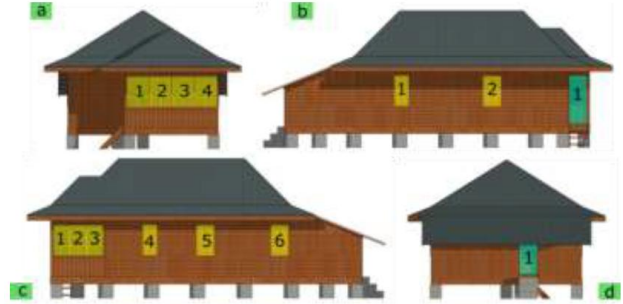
a. Persepektif bangunan, b. tampak samping kanan, c. tampak samping kiri, dan d. tampak depan
